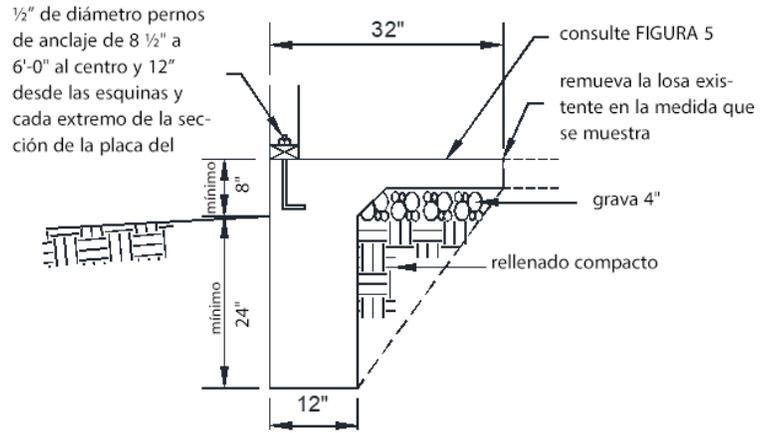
DETALLES TÍPICOS DE LA BASE/LOSA
